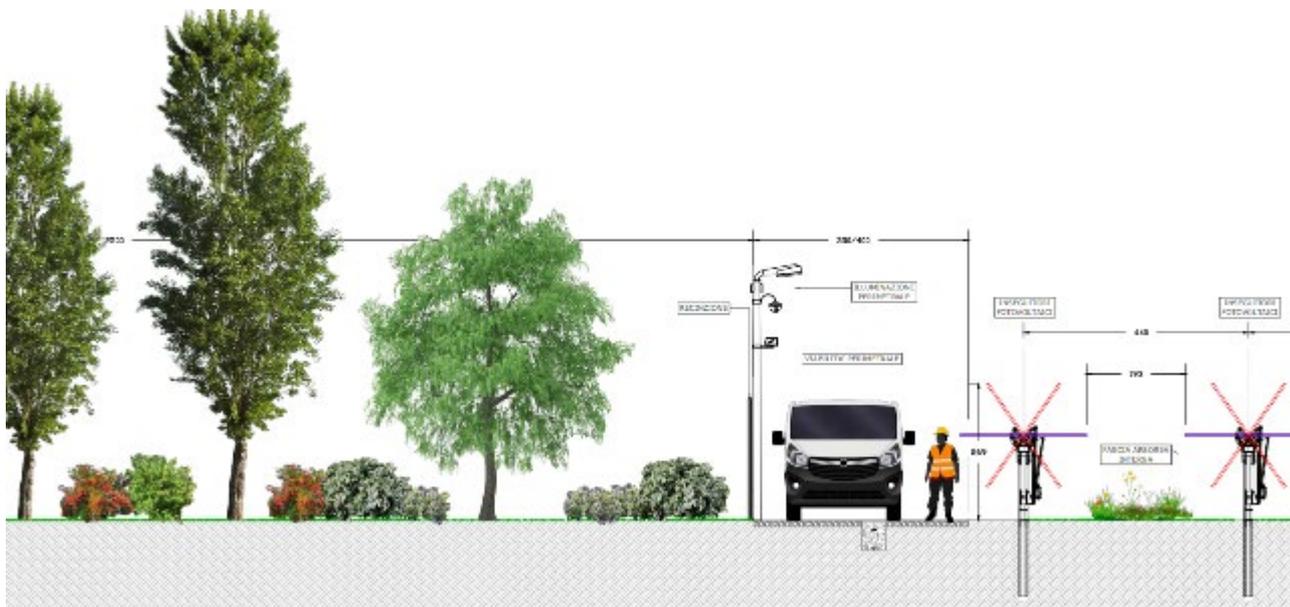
Sezione impianto fascia verde perimetrale verso corso d'acqua
